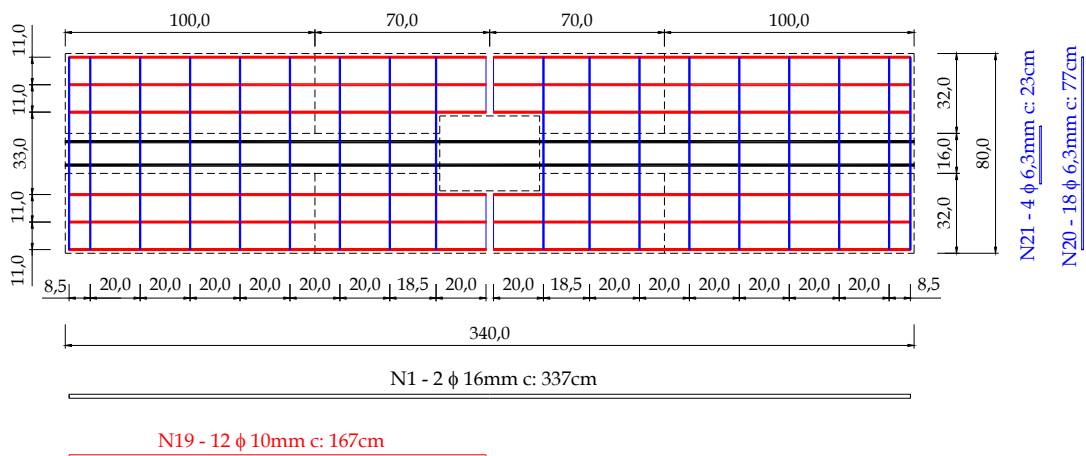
Armadura das vigas - parte 2 (dimensões em cm).
